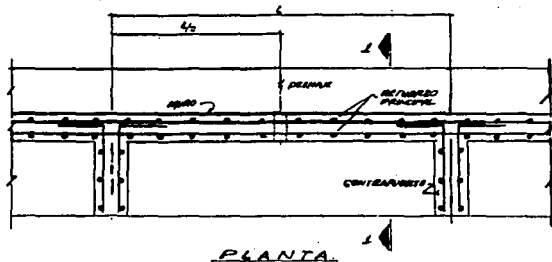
Planta de la geometría y armados de un muro de contención de concreto reforzado
